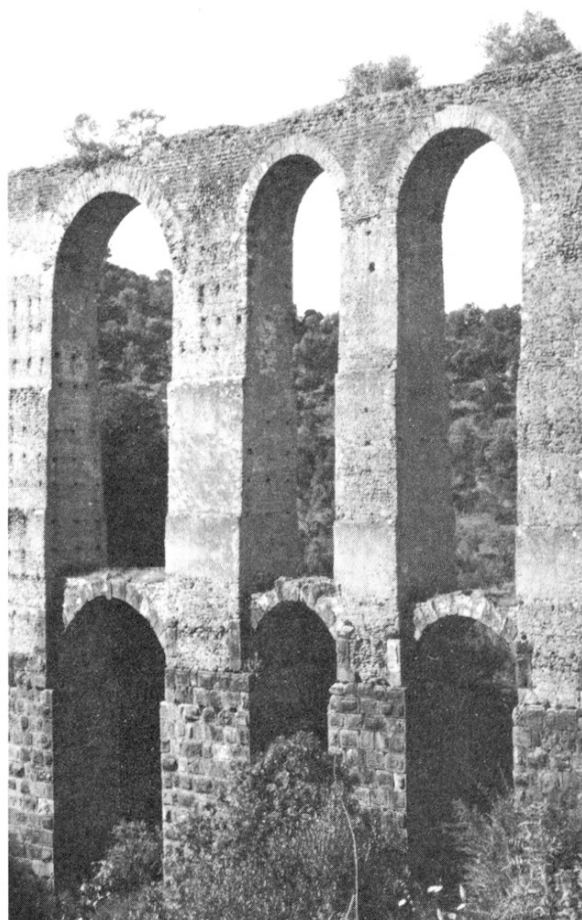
Le pont du chabet Ilelouïne. Arches entretoisées du second niveau.
